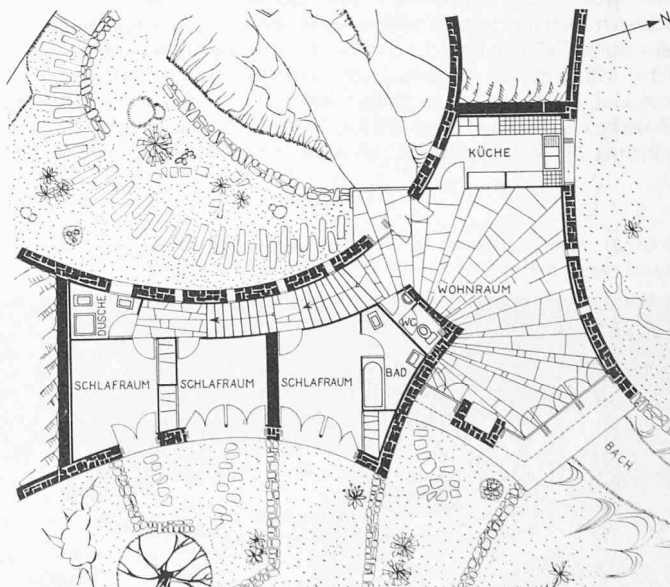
Individuell geplantes Einfamilienhaus auf drei Niveaux in Gaou Bénat. Architekten Le Fèvre und Aubert. Grundriss 1:250
